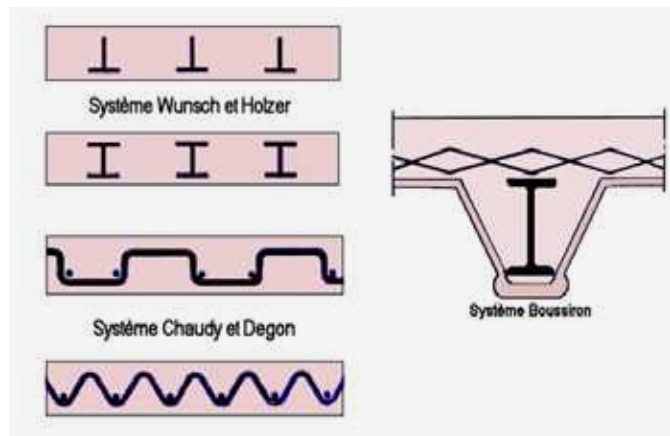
exemples des dispositions de ferrailage anciennes
